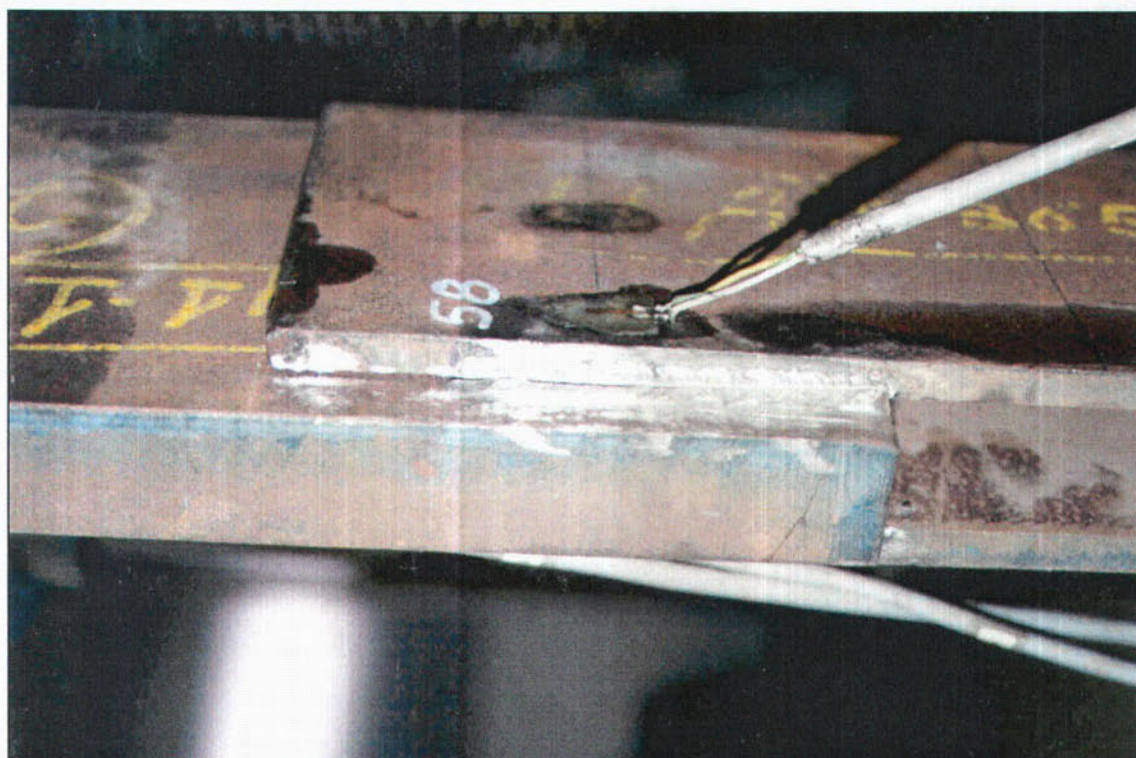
Nuevo detalle de rotura de soldadura en la probeta 2T, con la ubicación de una galga extensiométrica.
